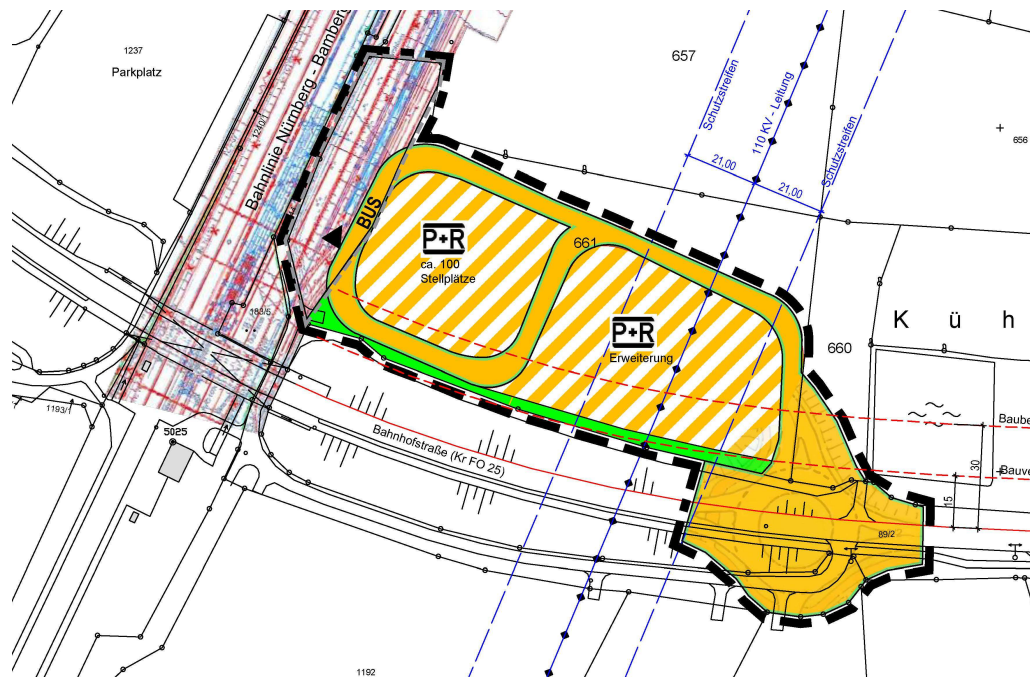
Planzeichnung des BBPs/GOPs Nr. 11/12-2 (Neuaufstellung) in der Fassung des Vorentwurfes vom 02.12.2014; (Darstellung genordet, o. M., Quelle: Stadt Forchheim)
